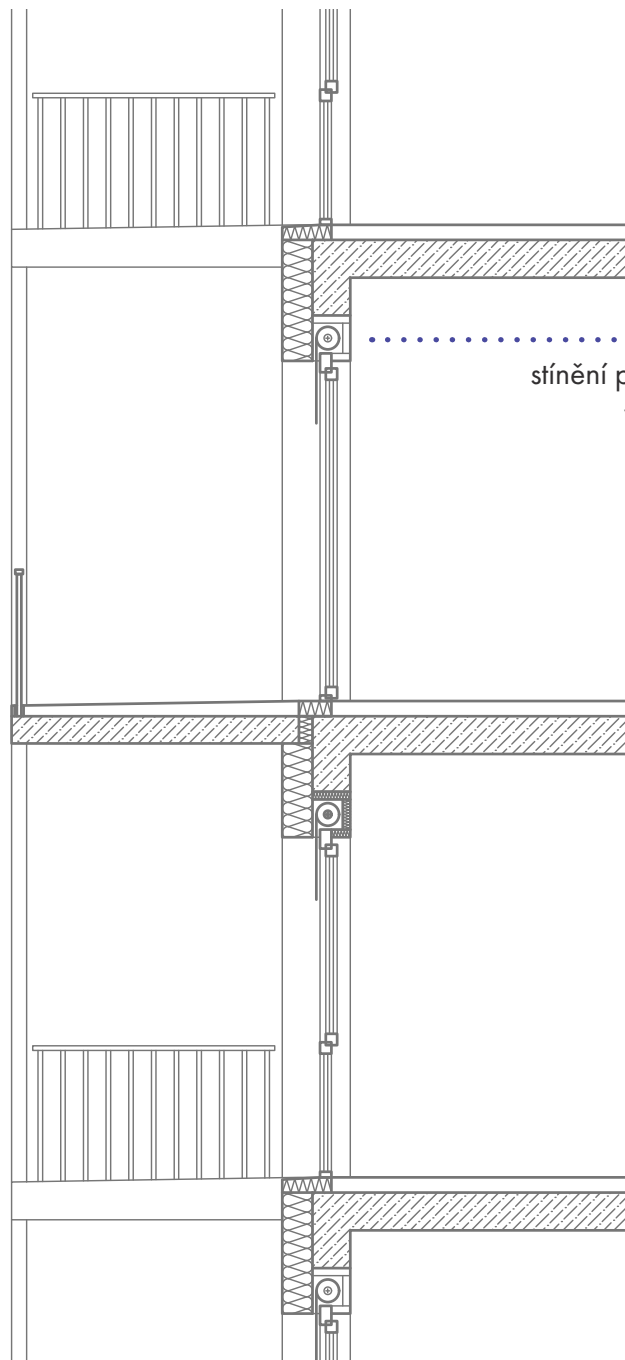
# DETAIL ŘEŠENÍ JIŽNÍ FASÁDY
